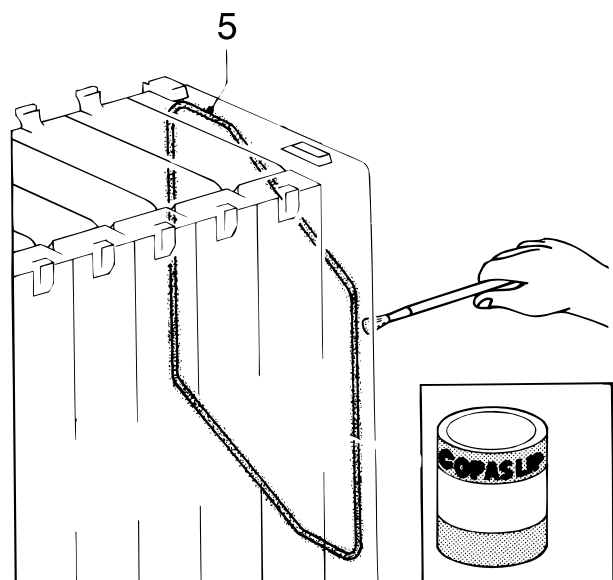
Abgassammelkasten (14) befestigen. Dichtschnur (5) mit Kleber befestigen.
